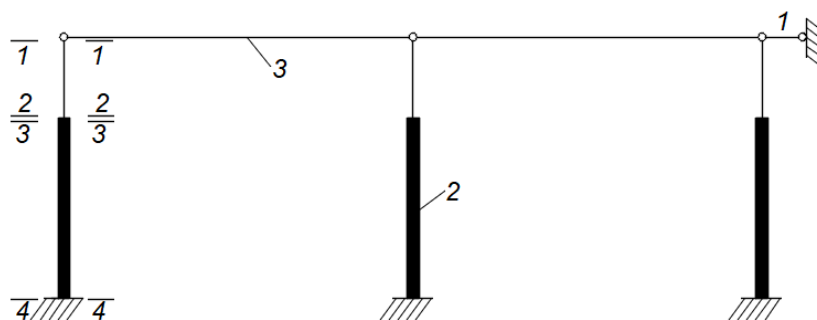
Основна система в розрахунках рам методом переміщень для будівлі з мостовими кранами:
